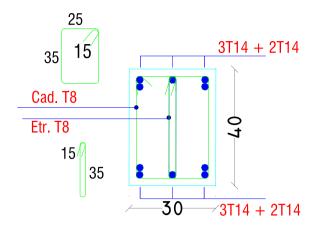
Ferraillage des poutres principales pour Etage 1,2 et 3.
